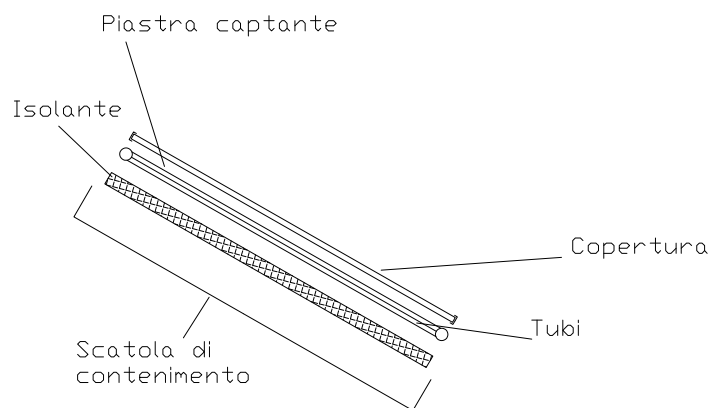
SEZIONE DI UN TIPICO COLLETTORE SOLARE PIANO
